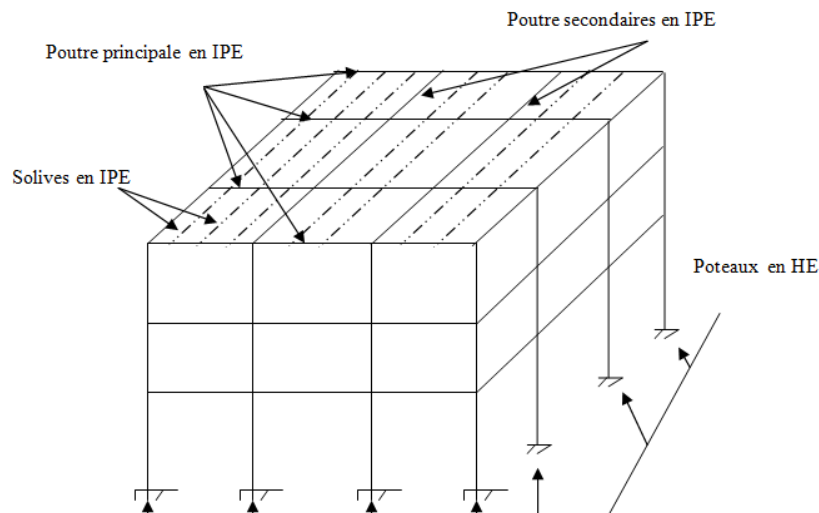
Ossature de bâtiment avec éléments structuraux
